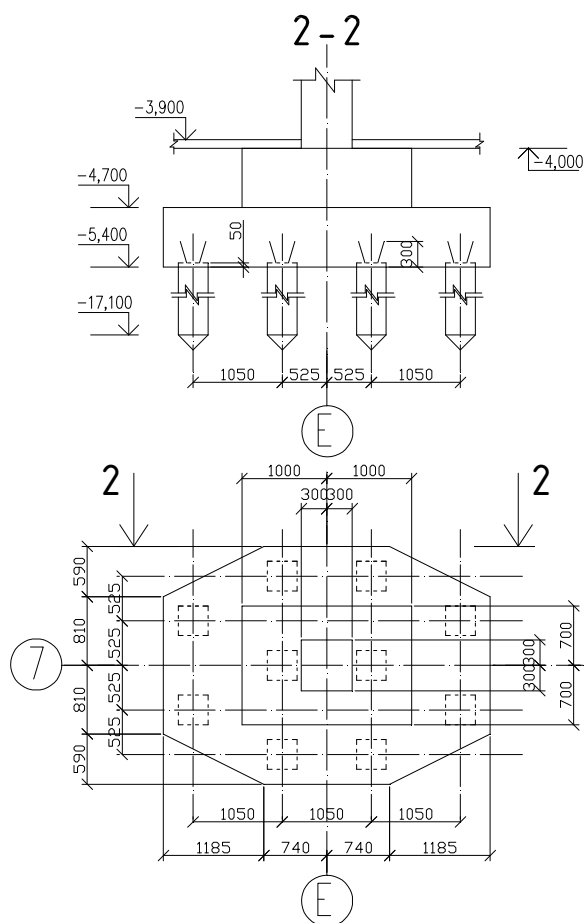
Пальовий фундамент під колону середнього ряду
